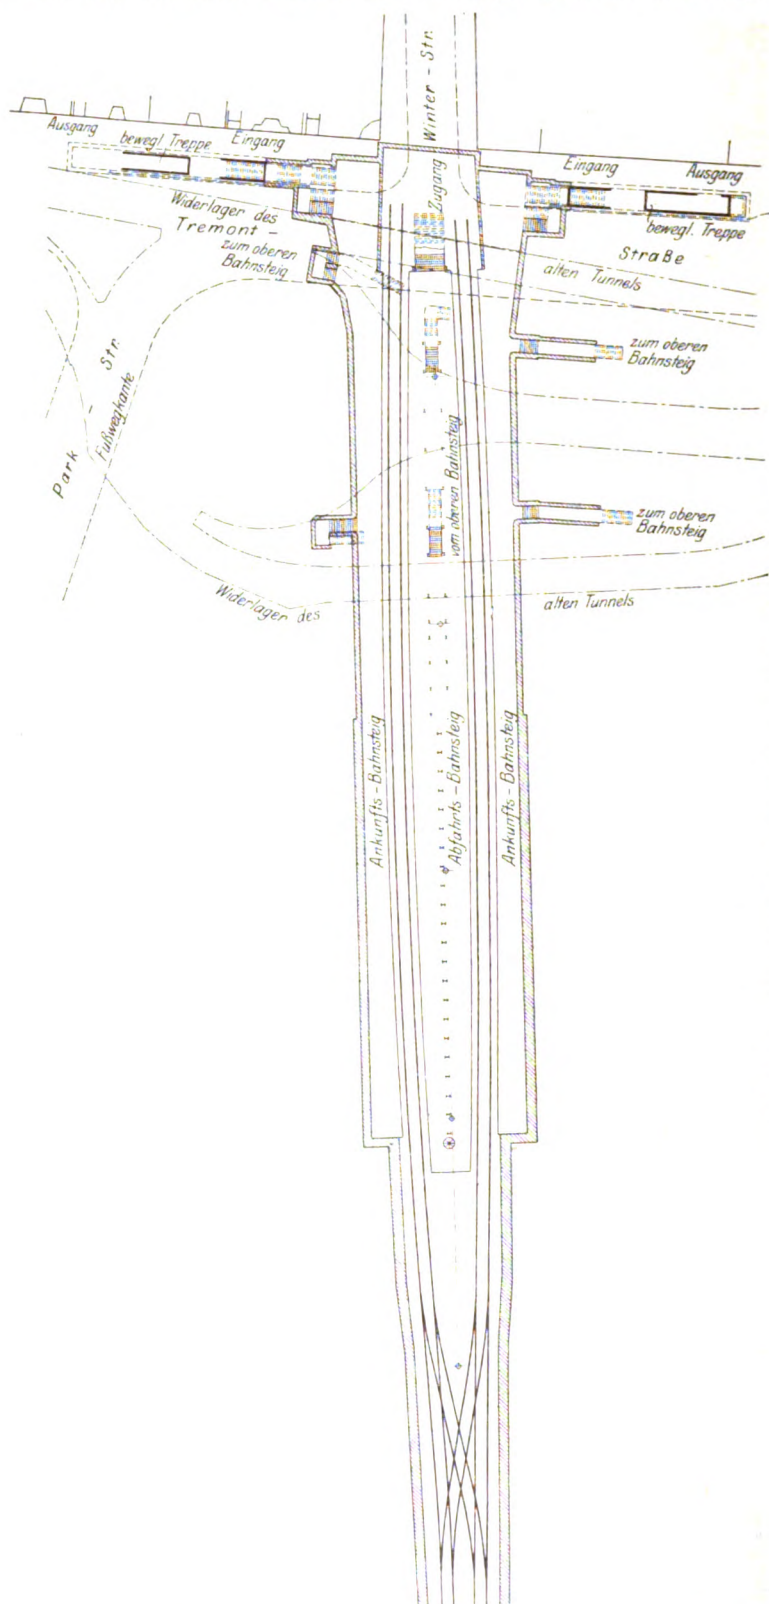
Lageplan der Station Parkstraße der Cambridge-Schnellbahn.
